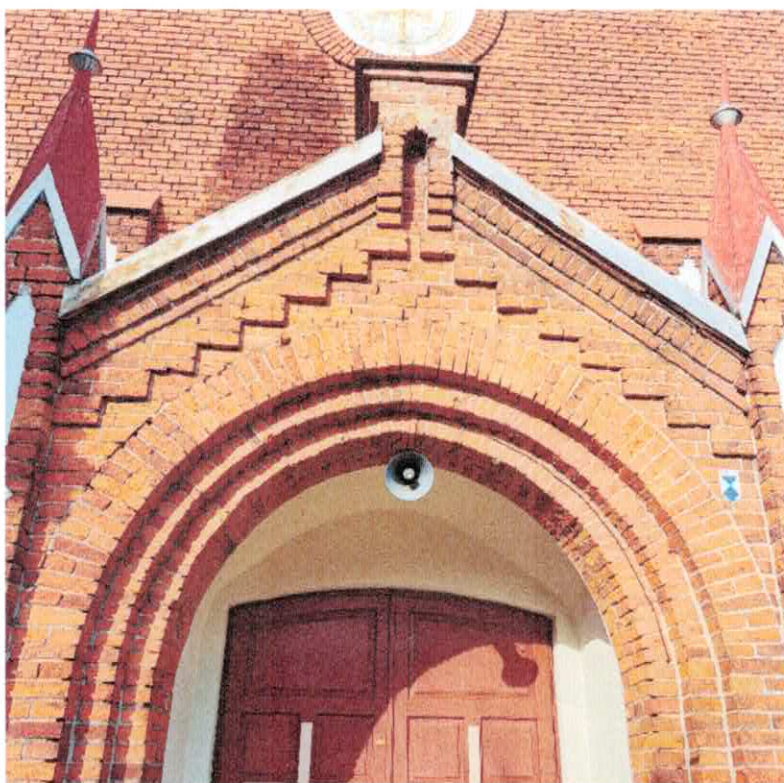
Szczegół przedstawiający stan porażenia murów elewacji kościoła przez mikroorganizmy
